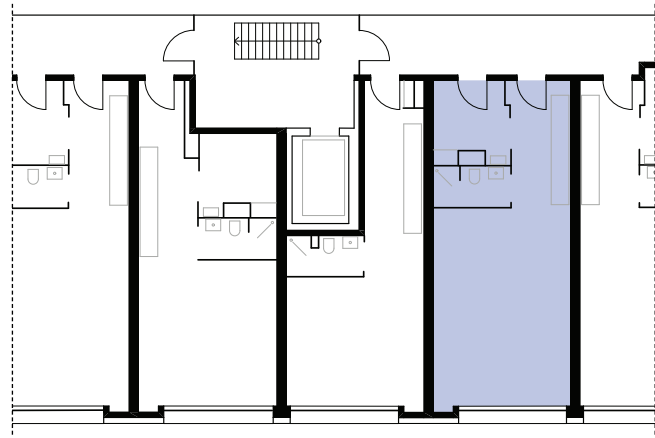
Grundrissausschnitt des Studierendenwohnheims Sarphatistraat
